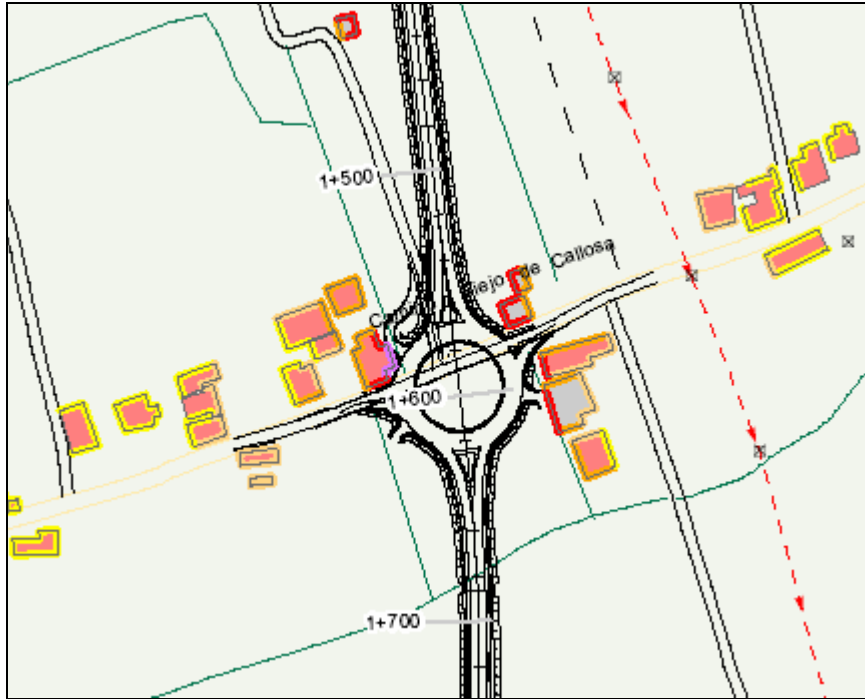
Niveles de Lden en Fachada en la zona del enlace con CV-91
